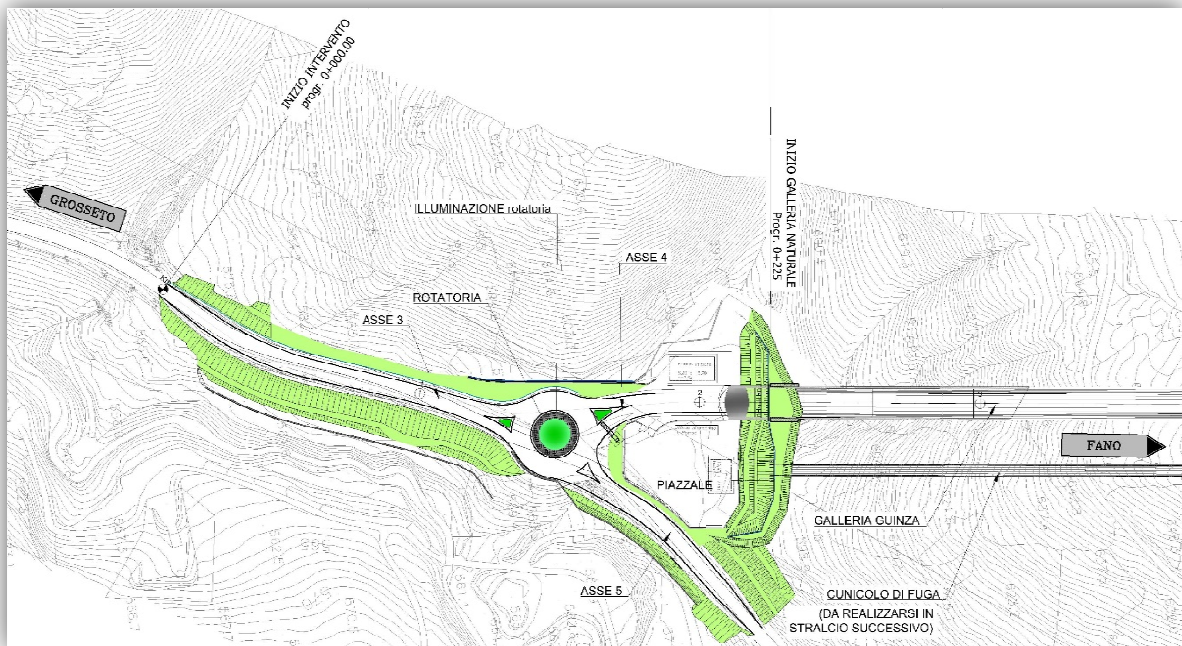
Planimetria di progetto dello svincolo 1 (lato Umbria).
